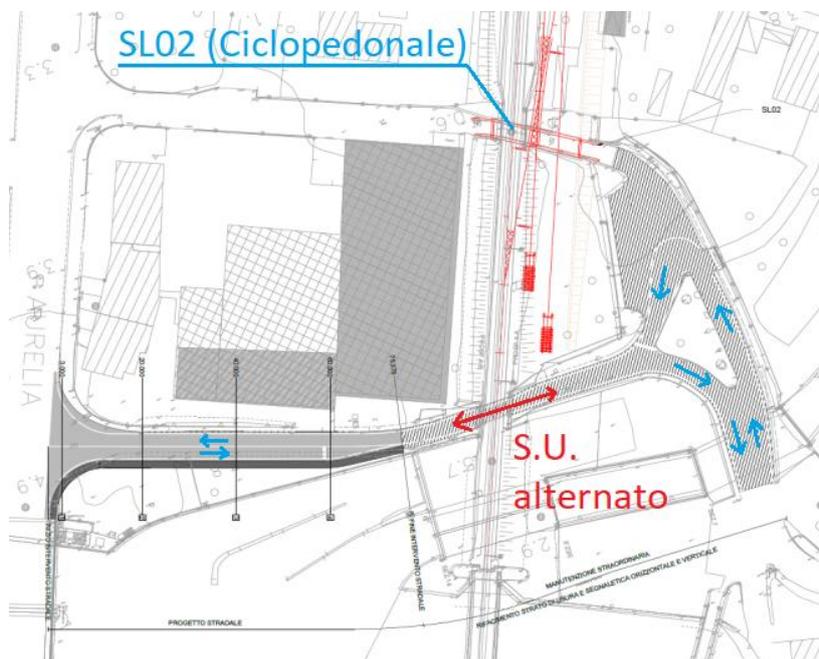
NV03 - Planimetria con indicazione della viabilità
